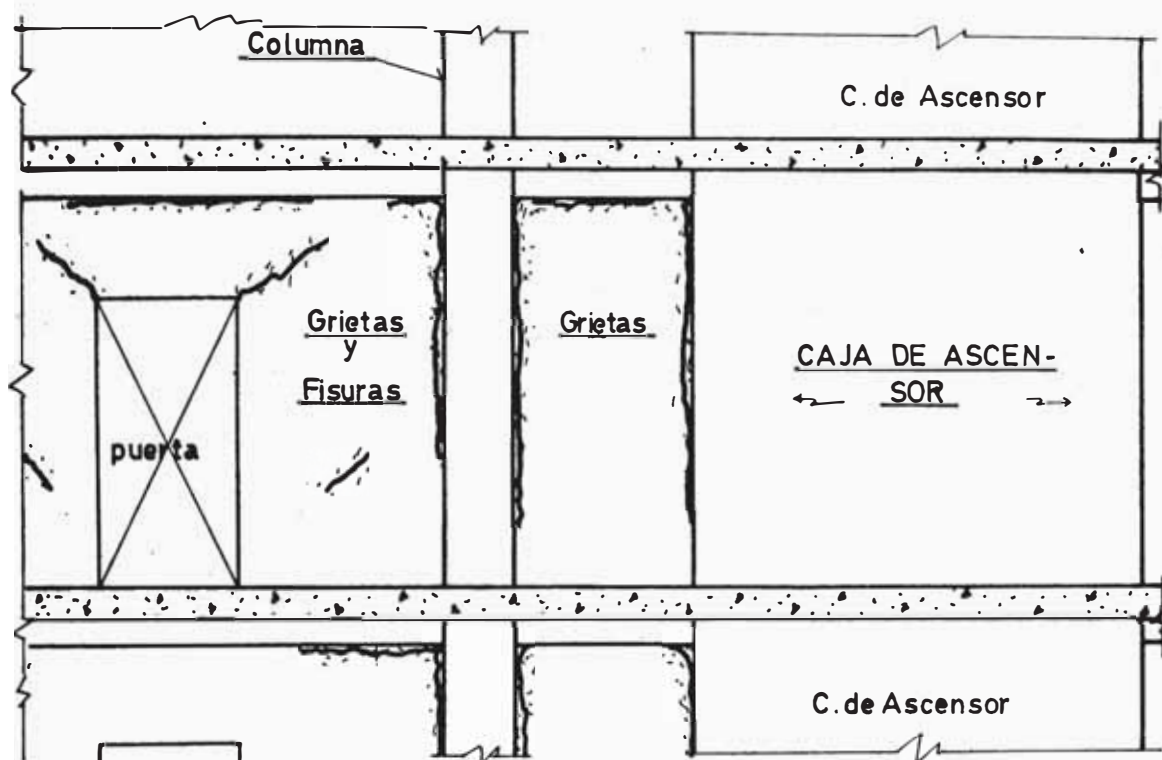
Fisuras y grietas en tabiques junto a Caja de Ascensor-Direc. secundaria. (Pab. Central)
